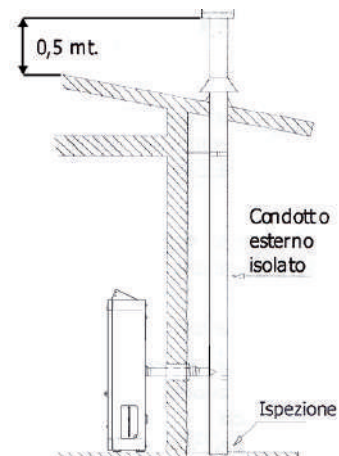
collegamento ad un condotto esterno con tubo isolato o doppia parete
